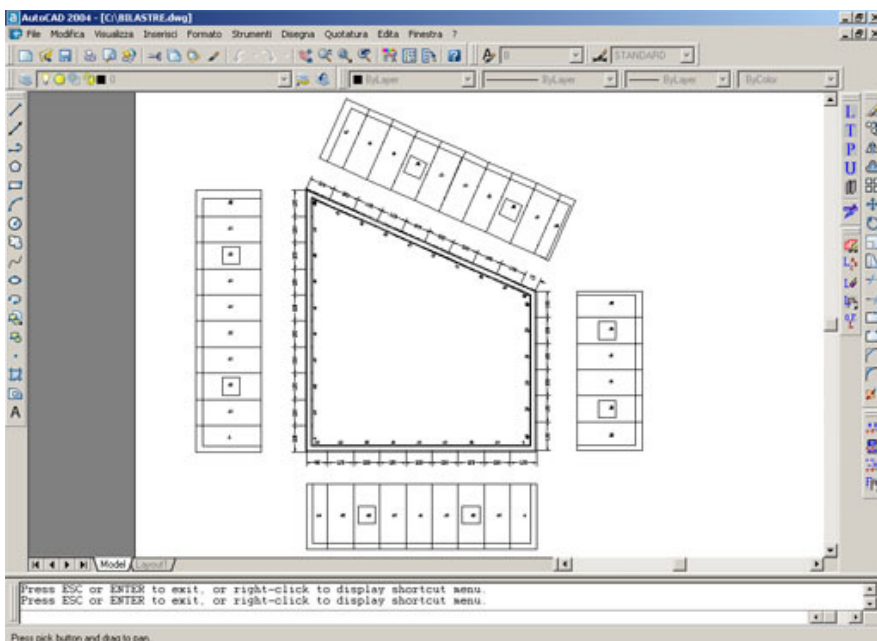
Bilastre: suddivisione pareti e generazione prospetti.
